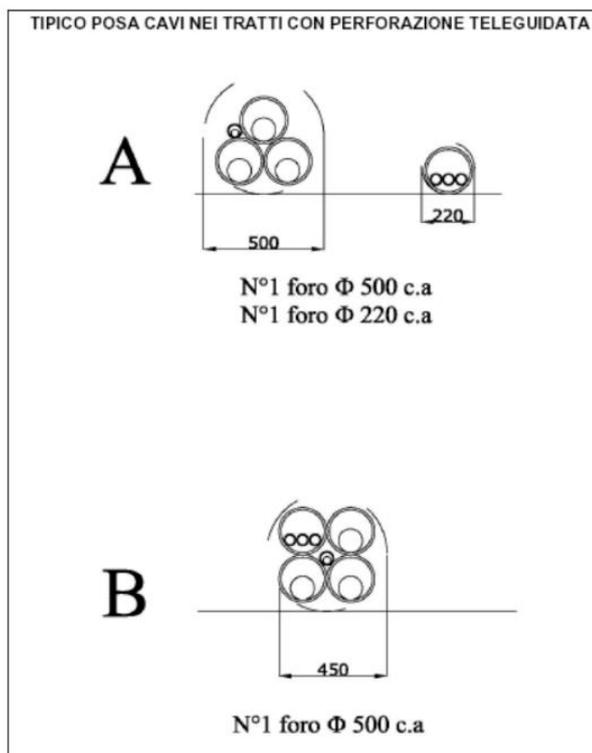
Sezione Tipo Attraversamento con foro pilota
